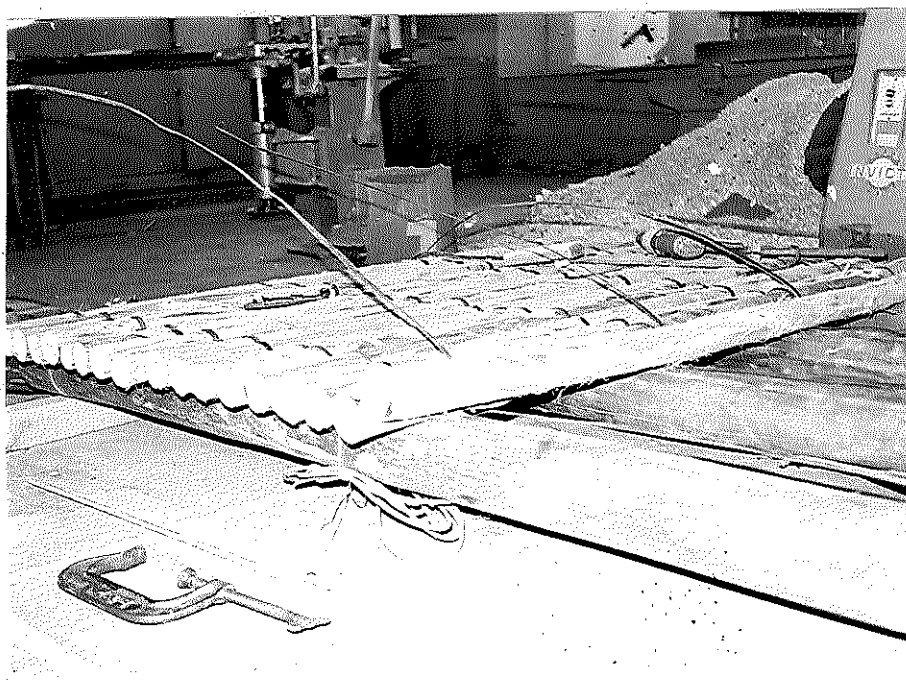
Ligação dos postes do tabuleiro nas vigas principais
